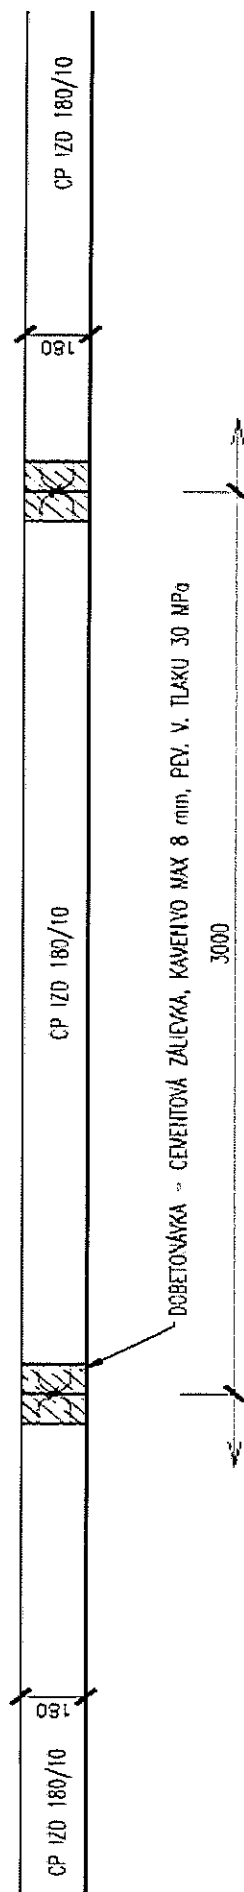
Detail spoja cestných panelov – pozdĺžny rez
